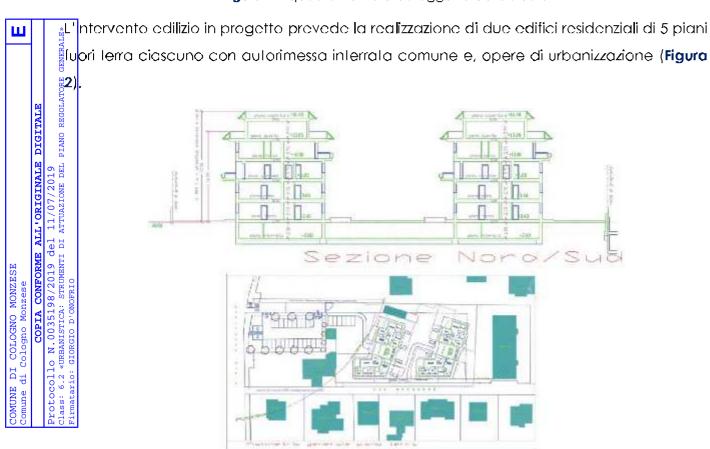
Sezione N/S e planimetria generale de l'area in oggetto
